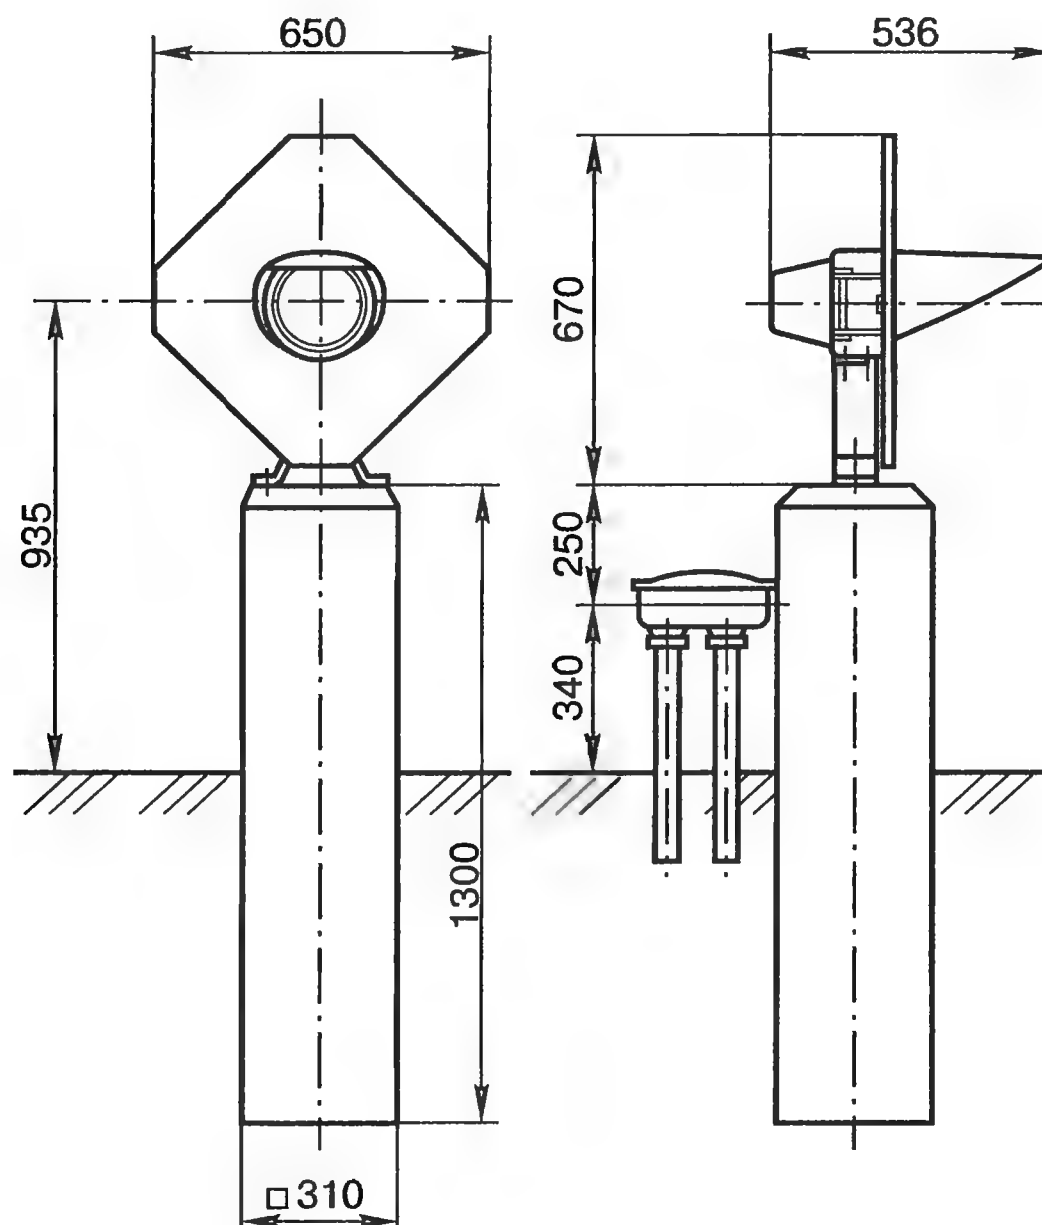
Однозначный карликовый светофор на железобетонном фундаменте
